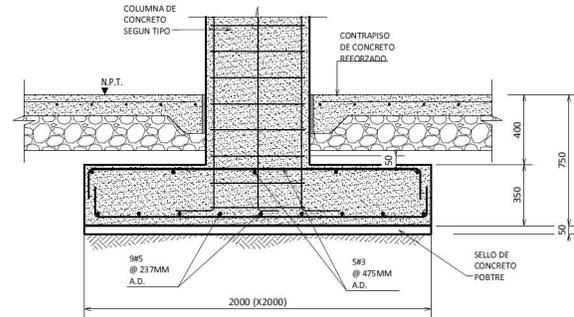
Detalle de una de las placas de fundación para sótano. Fuente: Constructora.
